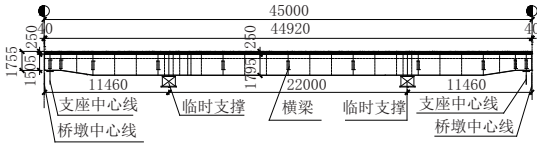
45 m 简支钢-混组合梁立面图(单位:mm)
